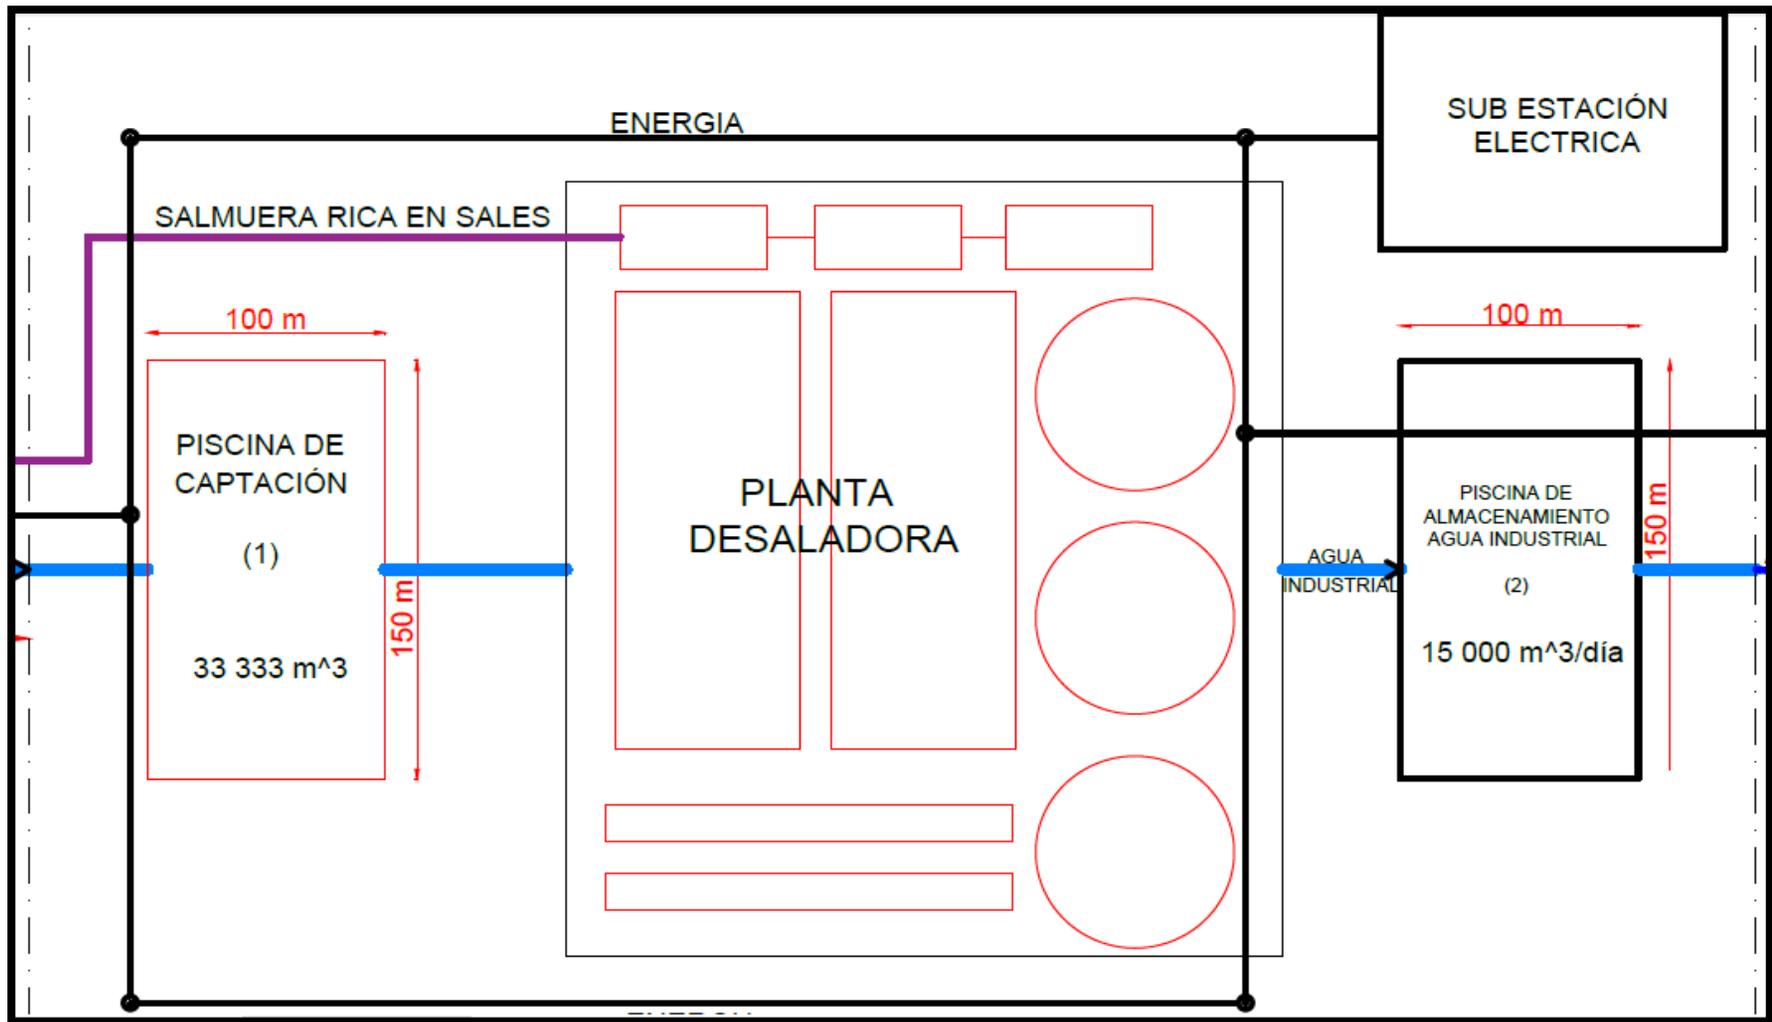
Plano de Planta desalinizadora (Fuente: Elaboración Propia)
